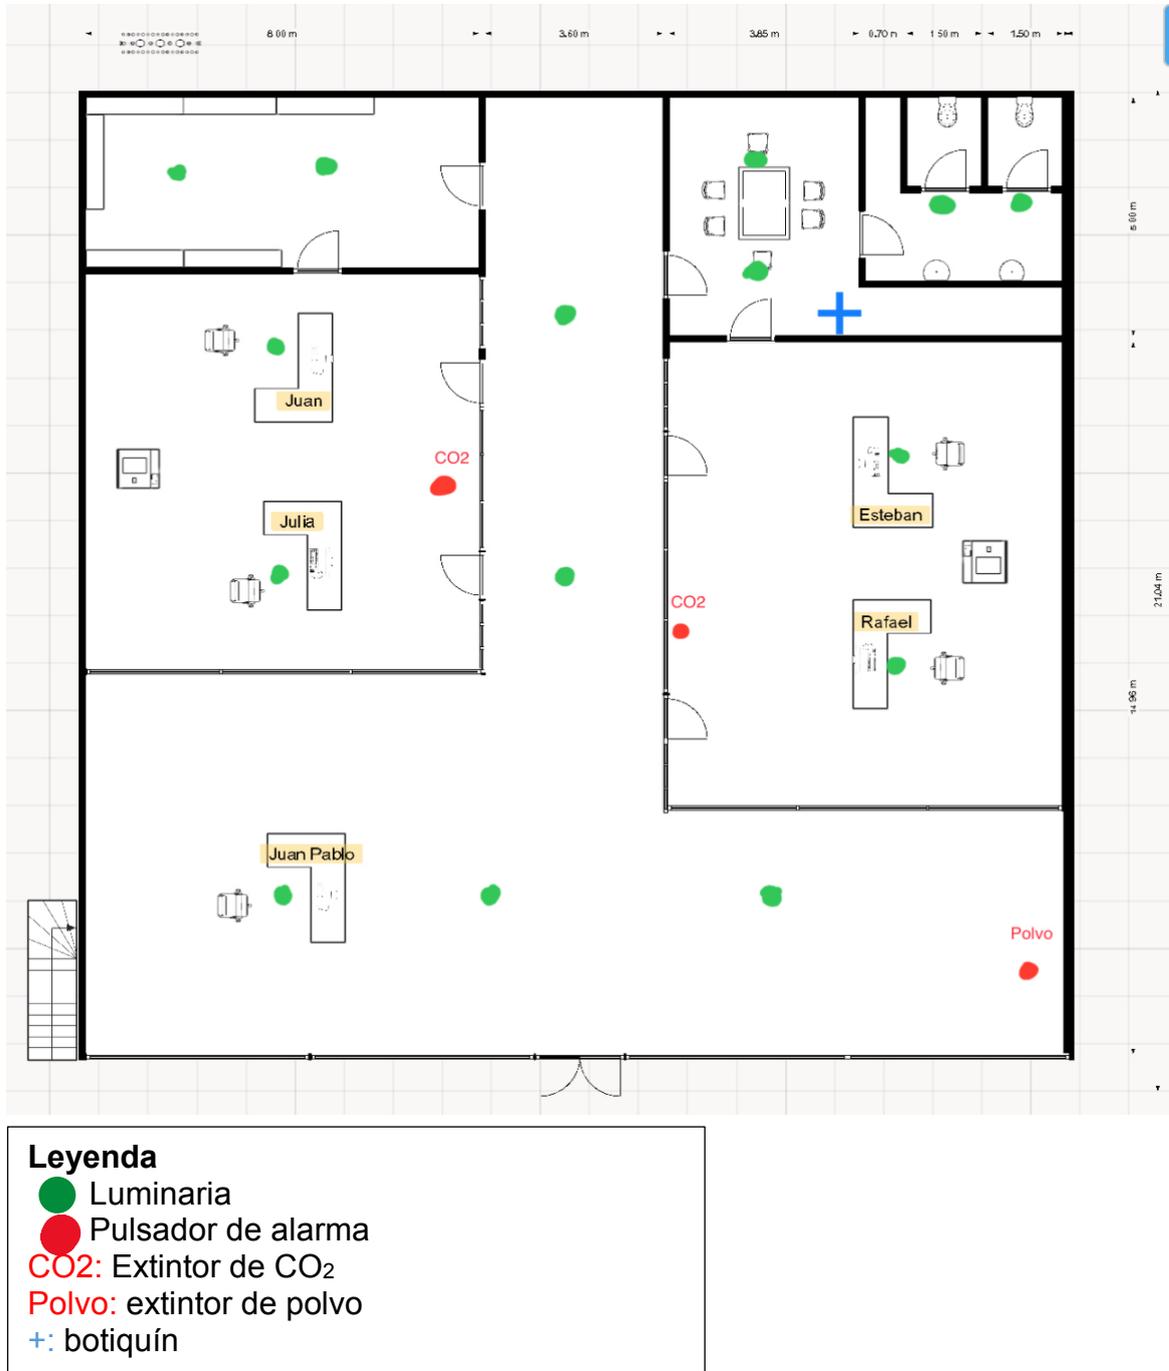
Croquis con leyenda de la planta baja de las oficinas de SALYMAR HOTELS S.L.
